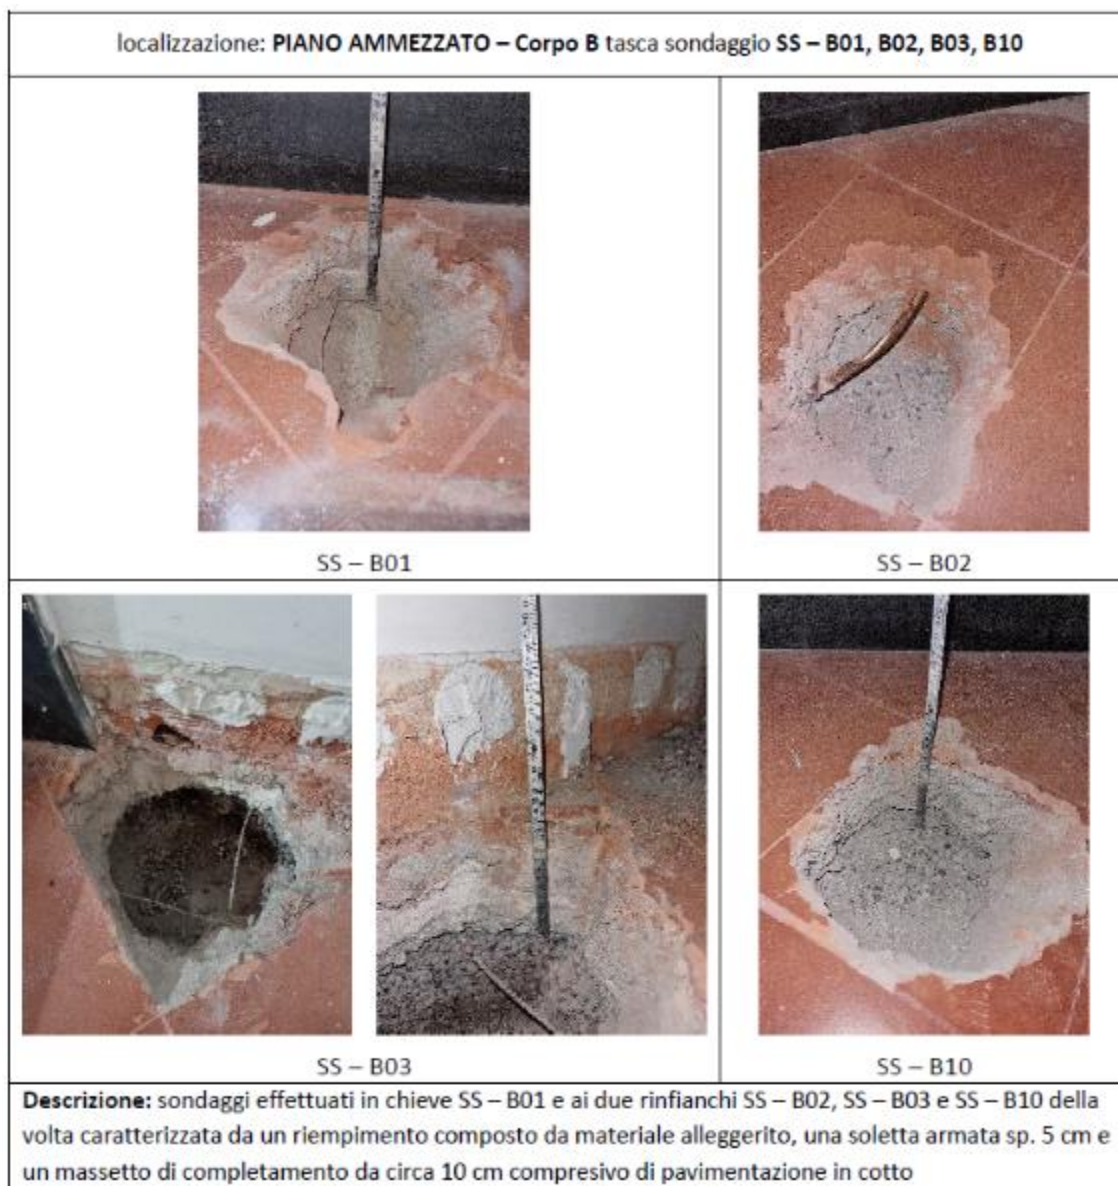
Rimozione della pavimentazione all'estradosso delle volte a botte di copertura del Piano Strada
